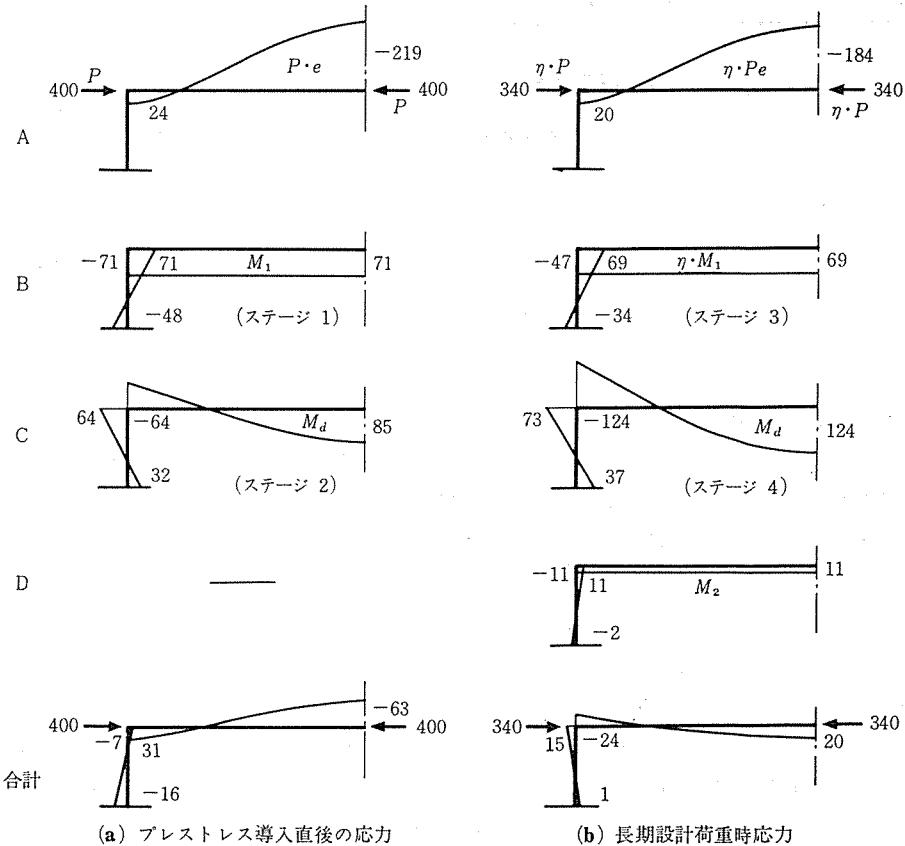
断面算定用応力—一体式、1階部分(単位:t·m, t)
